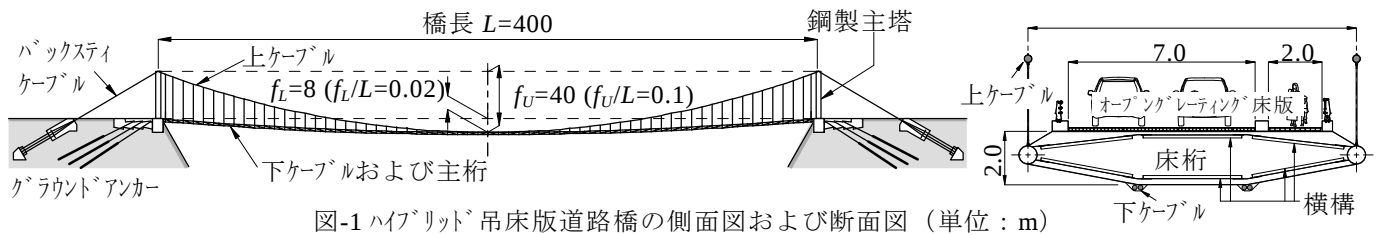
ハイブリッド吊床版道路橋の側面図および断面図 (単位: m)
